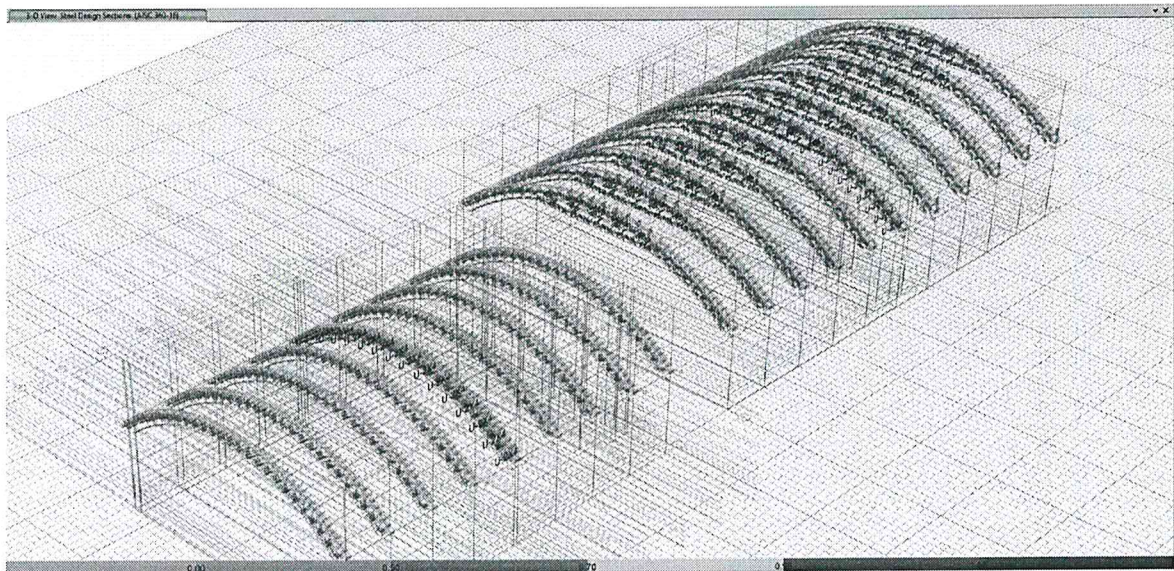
1: Vista en 3D de la Edificación 19-20 sistémico analizado. En esta vista se muestra los diseños de las estructuras metálicas consideradas en el diseño, el cual están en los rangos aceptables.
